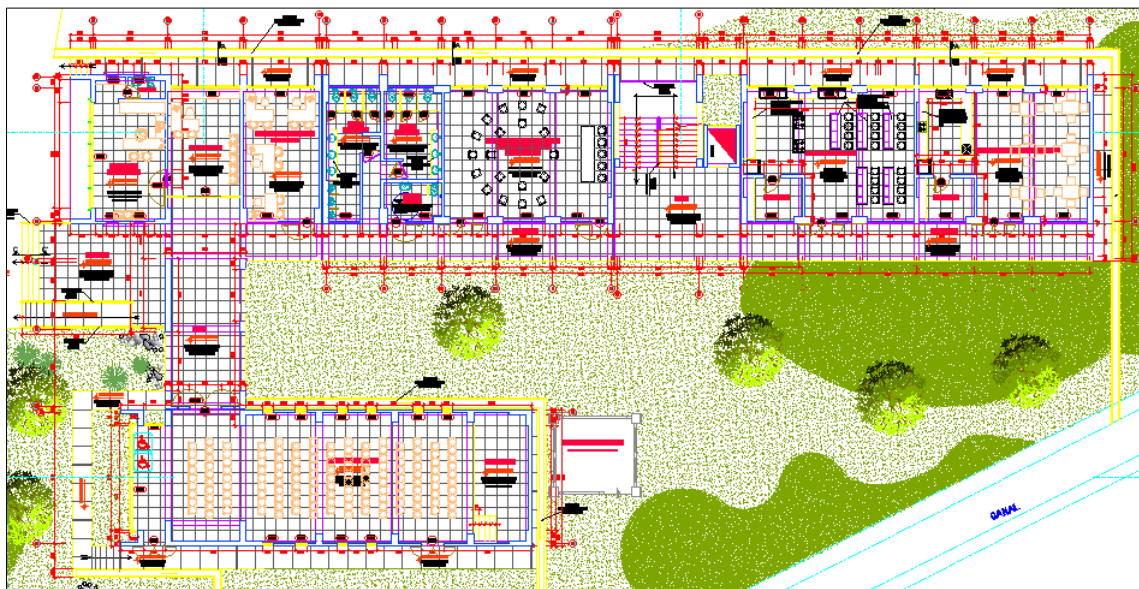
Distribución de la arquitectura (Piso 1) (Fuente: Planos de Arquitectura)
